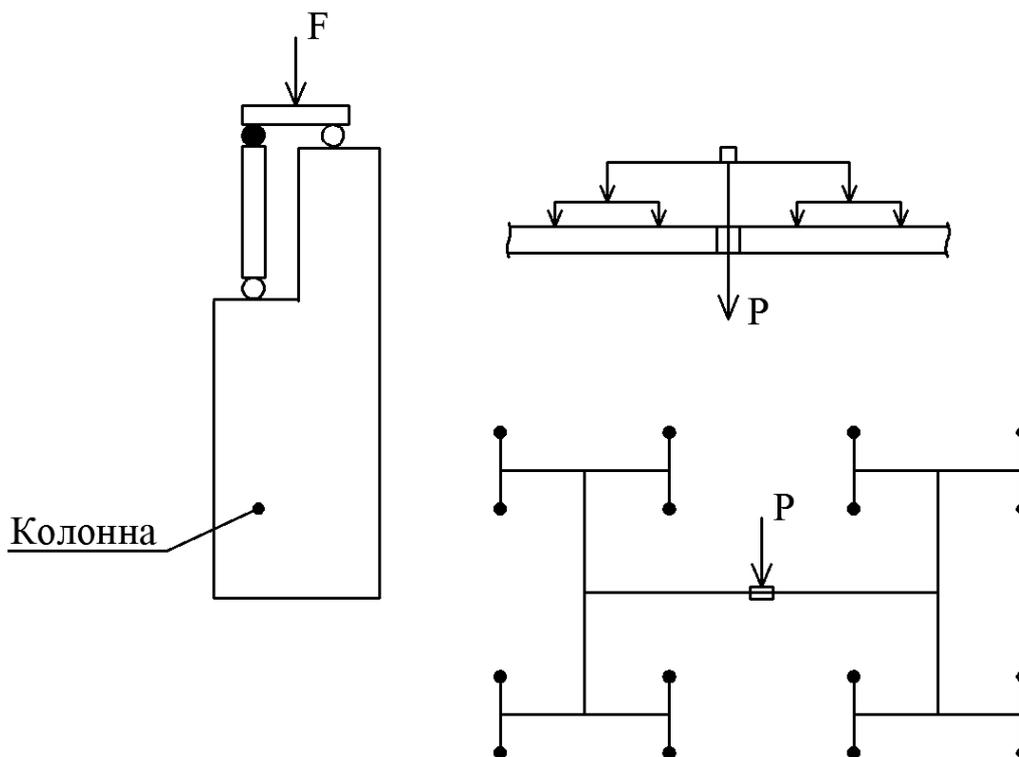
Схемы распределительных устройств для передачи нагрузки на конструкцию
